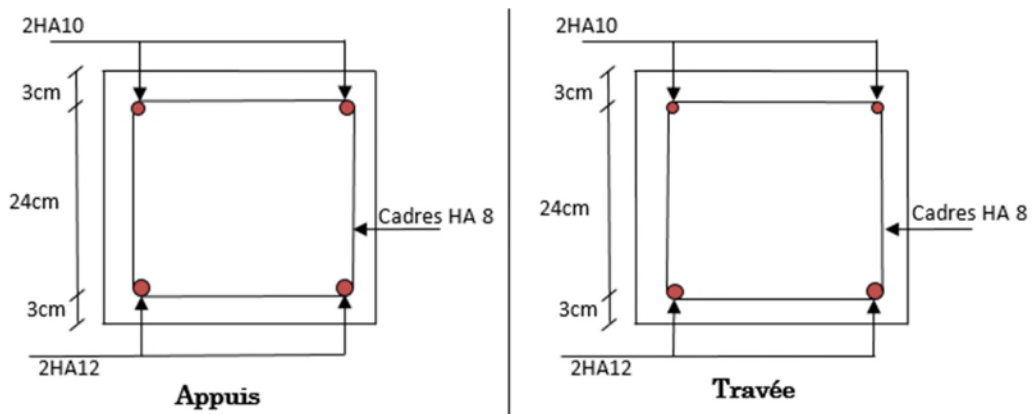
Schéma de ferrailage de la poutre de chaînage.
